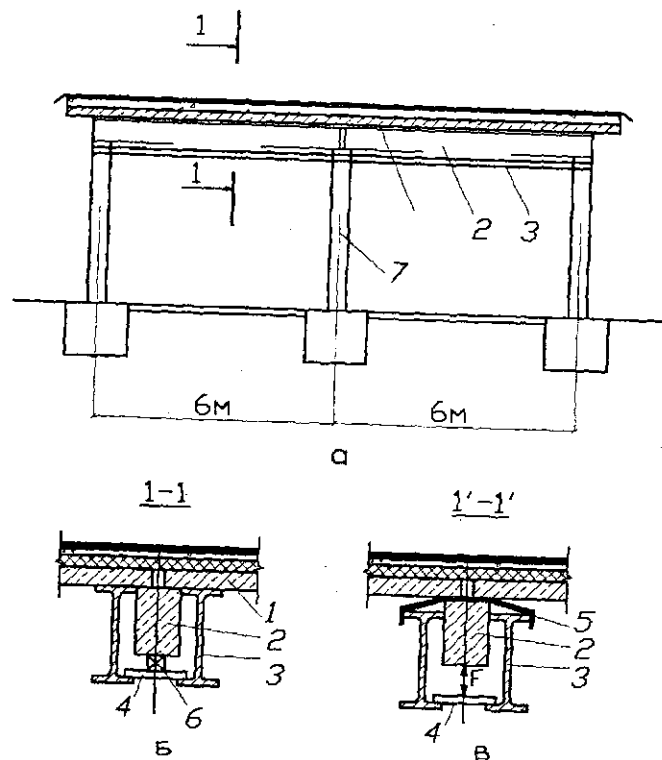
Реконструкция зала с разборкой средней колонны: а — поперечный разрез здания; б, в — сечение 1-1 покрытия соответственно в начале монтажа новых балок и 1'-1' — после поддомкравивания силой F; 1 — плита покрытия; 2 — железобетонная балка пролетом 6 м; 3 — двутавр пролетом 12 м; 4 — пластина; 5 — арматура; 6 — домкрат; 7 — демонтируемая колонна
